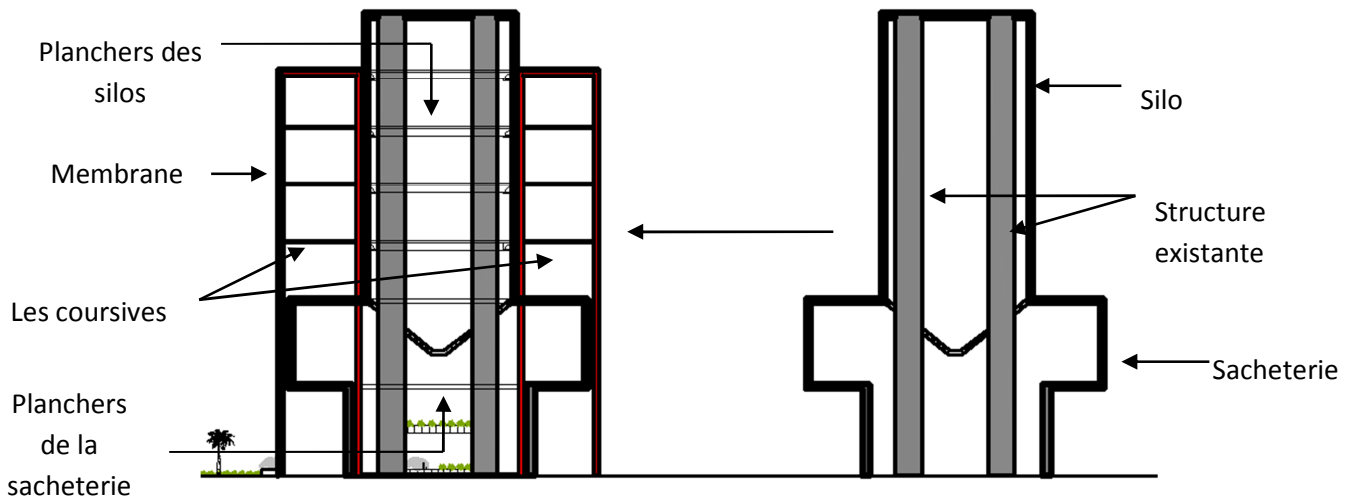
coupe représentatif de la disposition de la membrane par rapport au bâtiment des silos (avant et après) intervention, source: auteur
